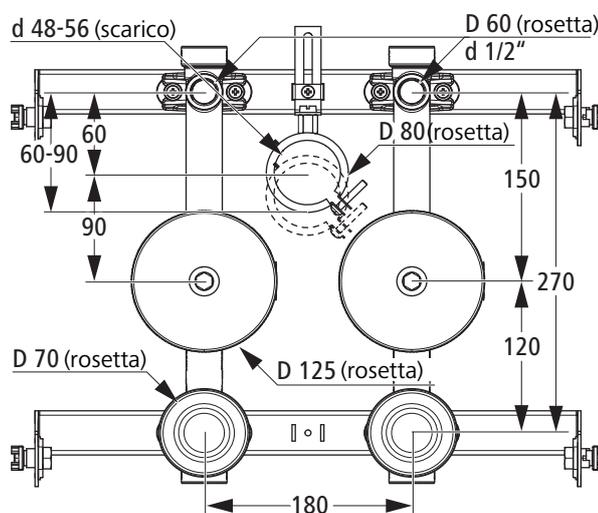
Misure di montaggio del lavabo set sotto muro Optivis-Tec, distanza delle dime set di montaggio valvola sotto muro = 180 mm
